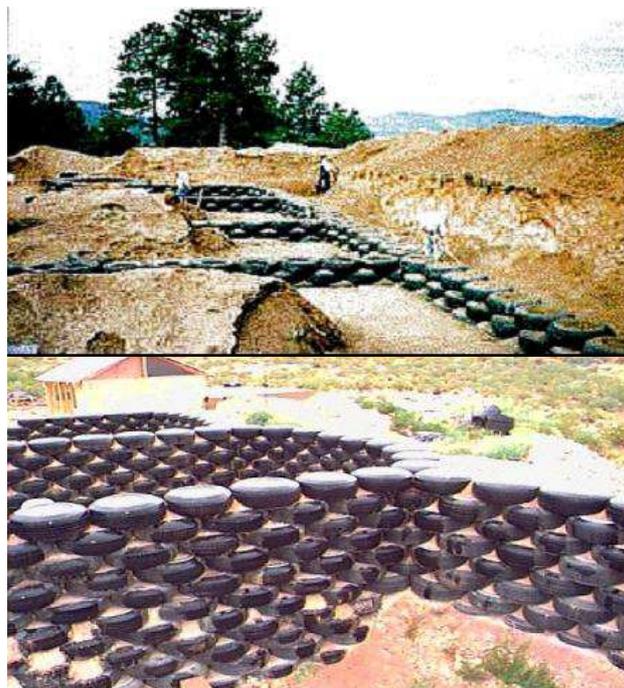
Construcción de cimientos y muros de viviendas con neumáticos usados
